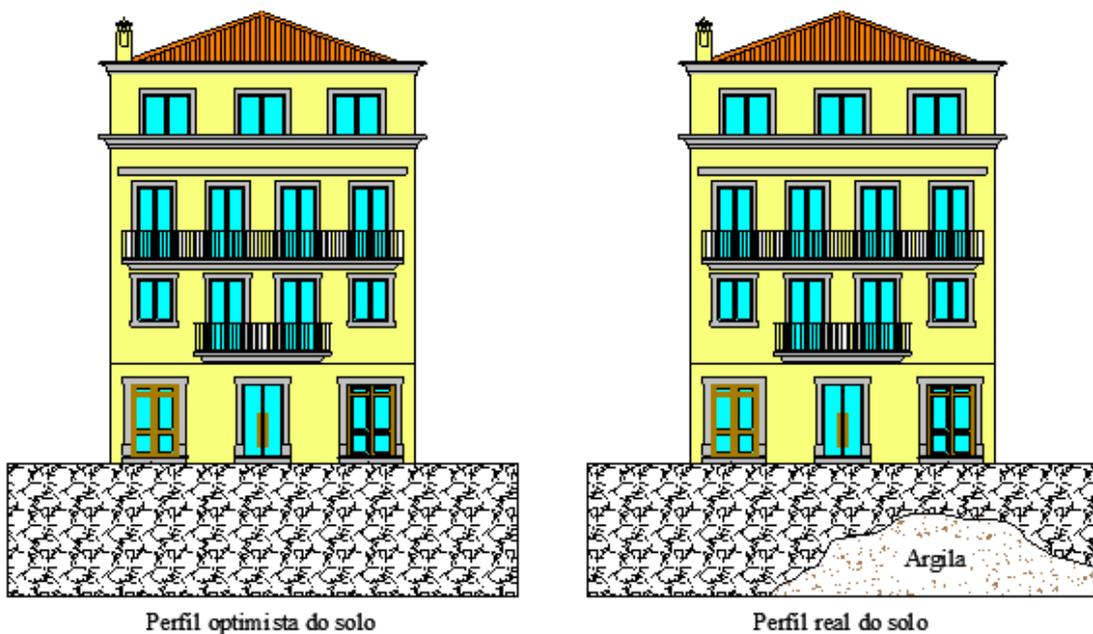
Exemplo de adoção de um perfil de terreno otimista quando na realidade existe uma camada de argila que poderá provocar assentamentos na estrutura do prédio e, conseqüentemente, fissuras na estrutura (Modificado, Schnaid et al., 2005).
